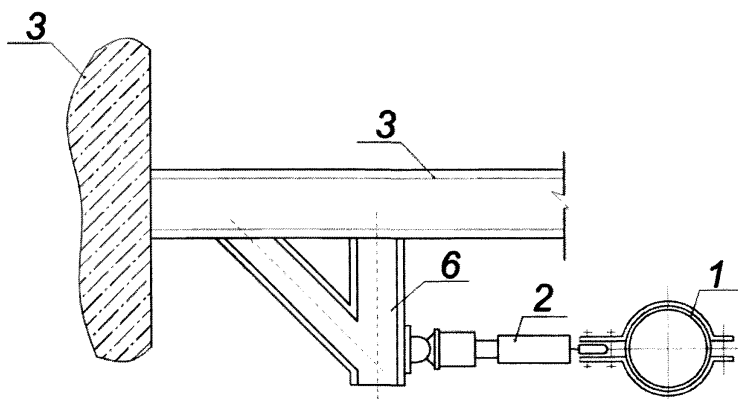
Пример назначения границ между опорными конструкциями и строительными конструкциями
